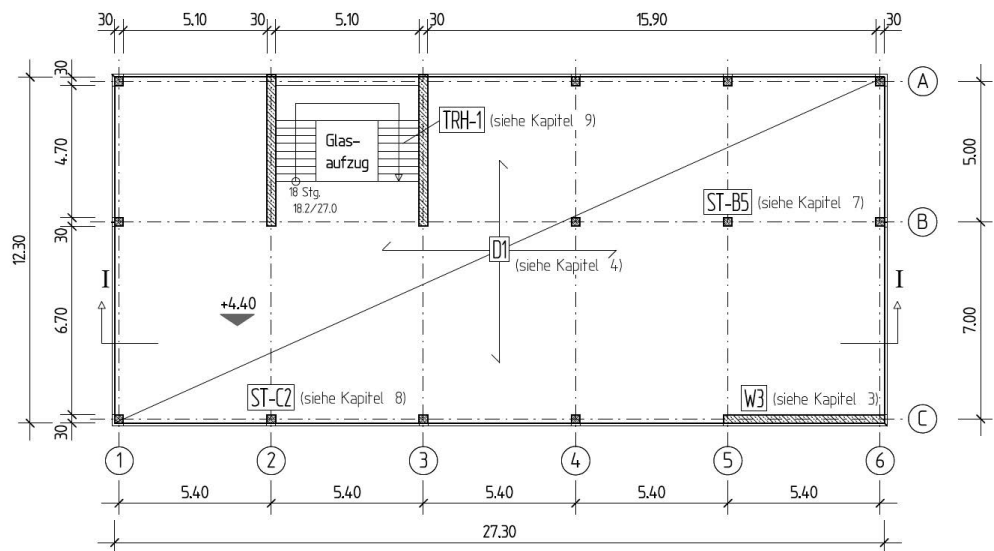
Grundriss im Regelgeschoss
